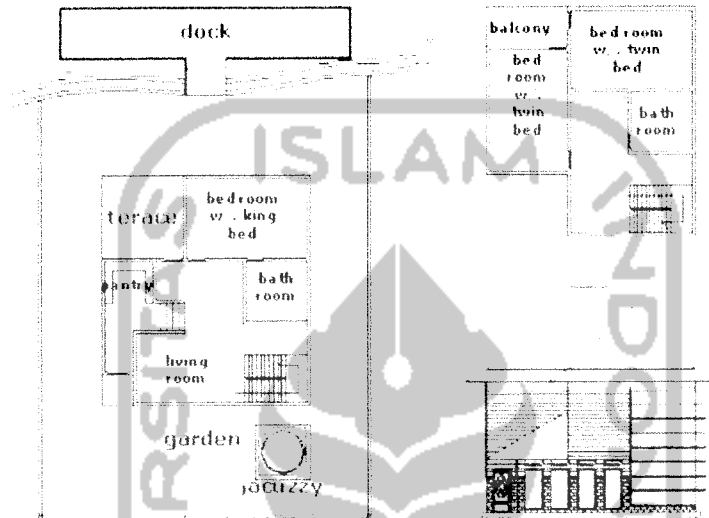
Denah dan Tampak Type Executive Suite
